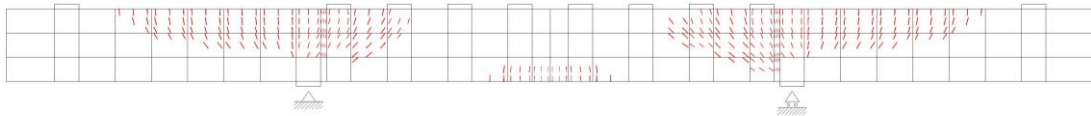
破壊時の変形及びひび割れ状態 (Case No. 13)
